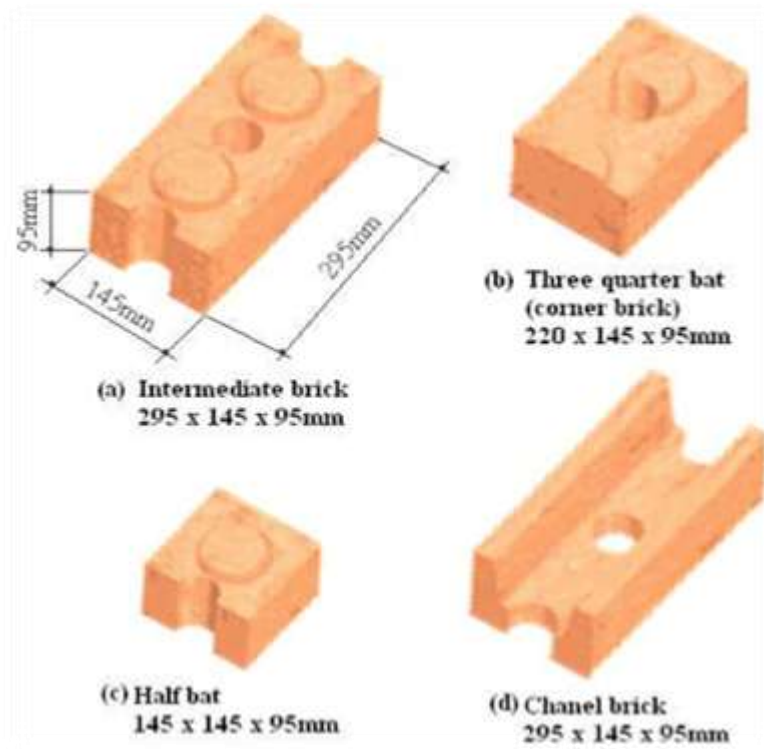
Sistema constructivo para muros: Auram (Simion, 2009)
